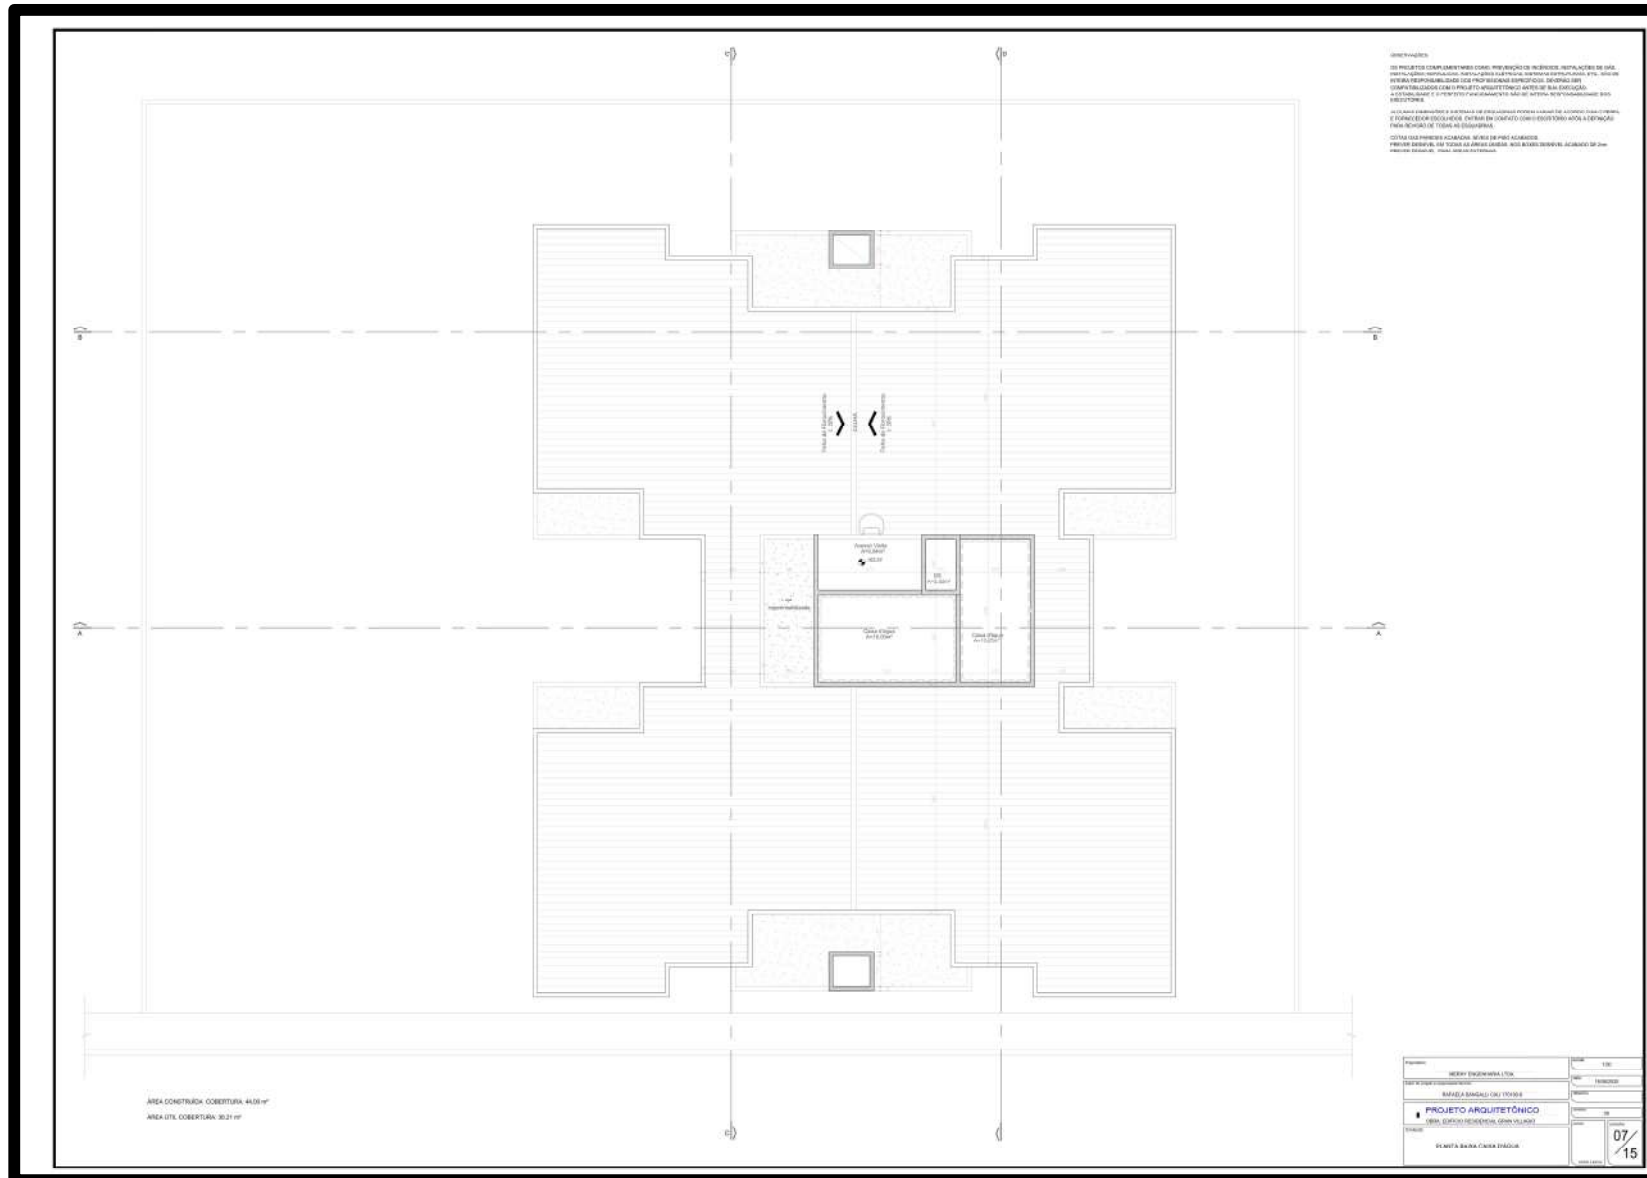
Caixa d'água. Fonte: Construtora Merhy (2020).
